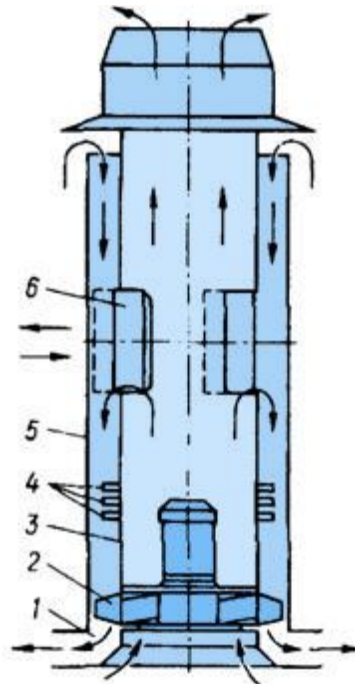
Вентиляційна шахта установки ПВУ-4М:
